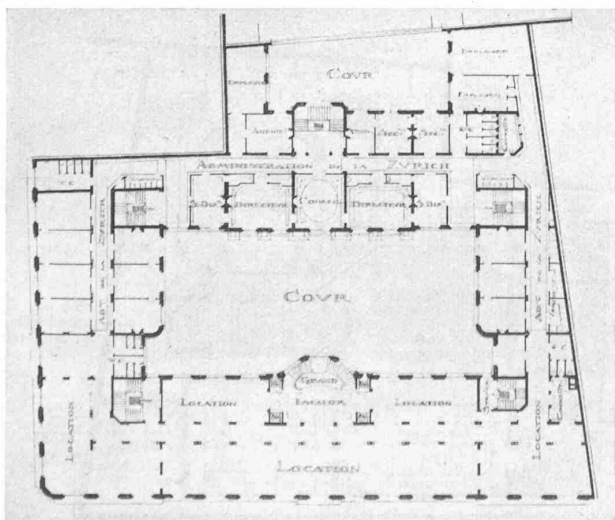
Obergeschoss-Grundriss. 1:800. — Entwurf Arch. Patouillard, Paris. — Abb. 12. Schnitt durch Vorder- und Hintergebäude. — 1:600.
